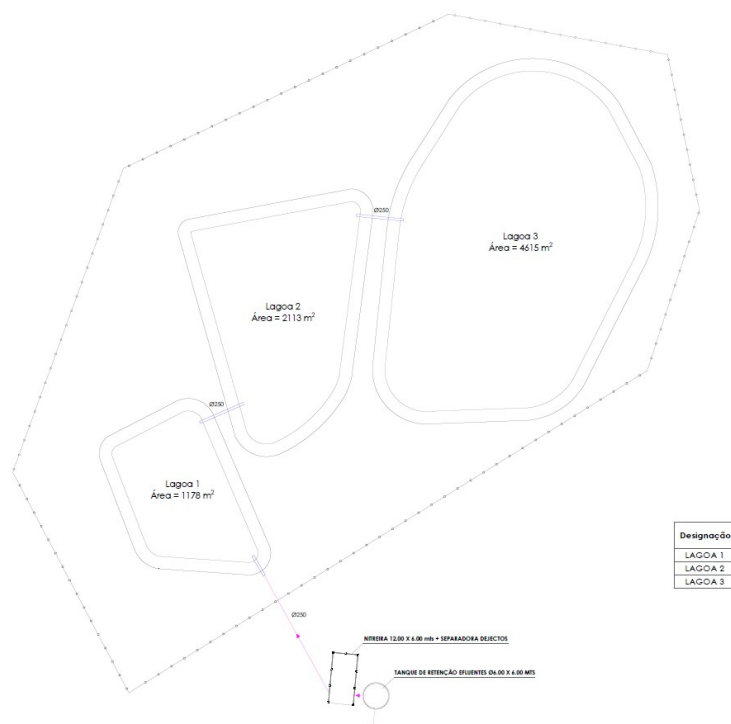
Extrato da planta de implantação do sistema de armazenamento de efluentes pecuários após as obras de ampliação.
